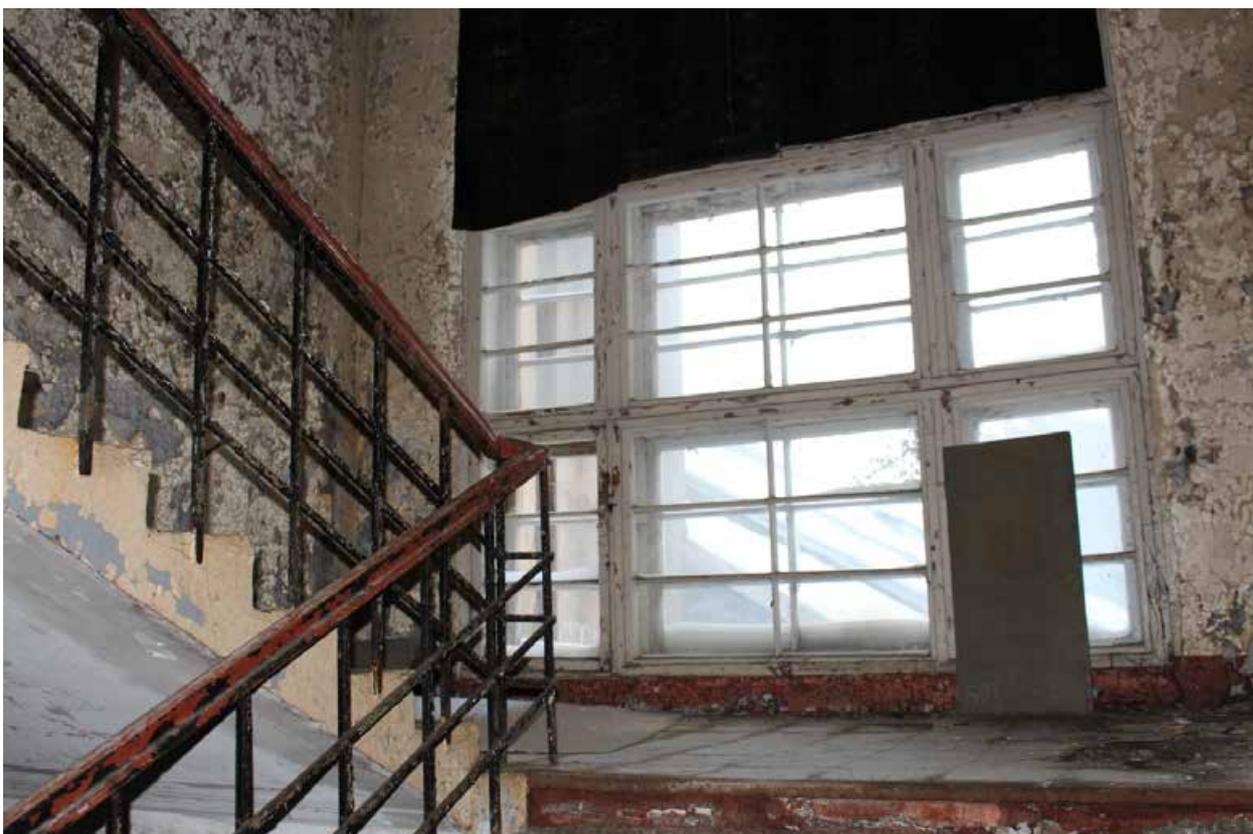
Междуэтажная площадка Л-2, 3 этаж.
